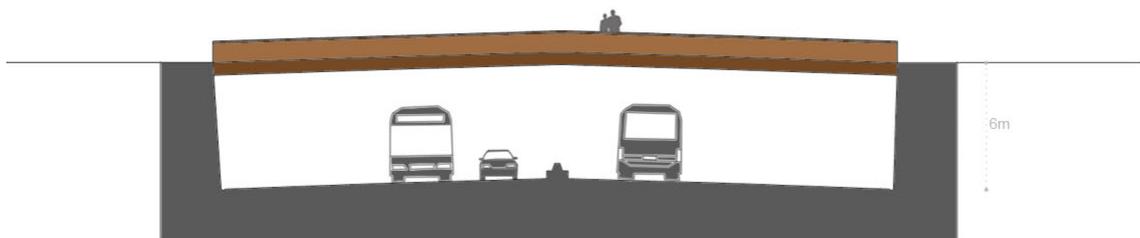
Corte da Avenida Padre Cruz, com proposta de rebaixamento e passagem pedonal.
